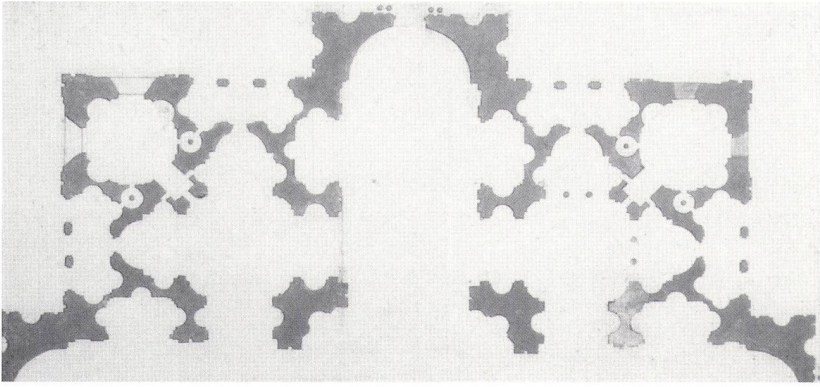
Bramante, Grundrissentwurf für Sankt Peter in Rom
